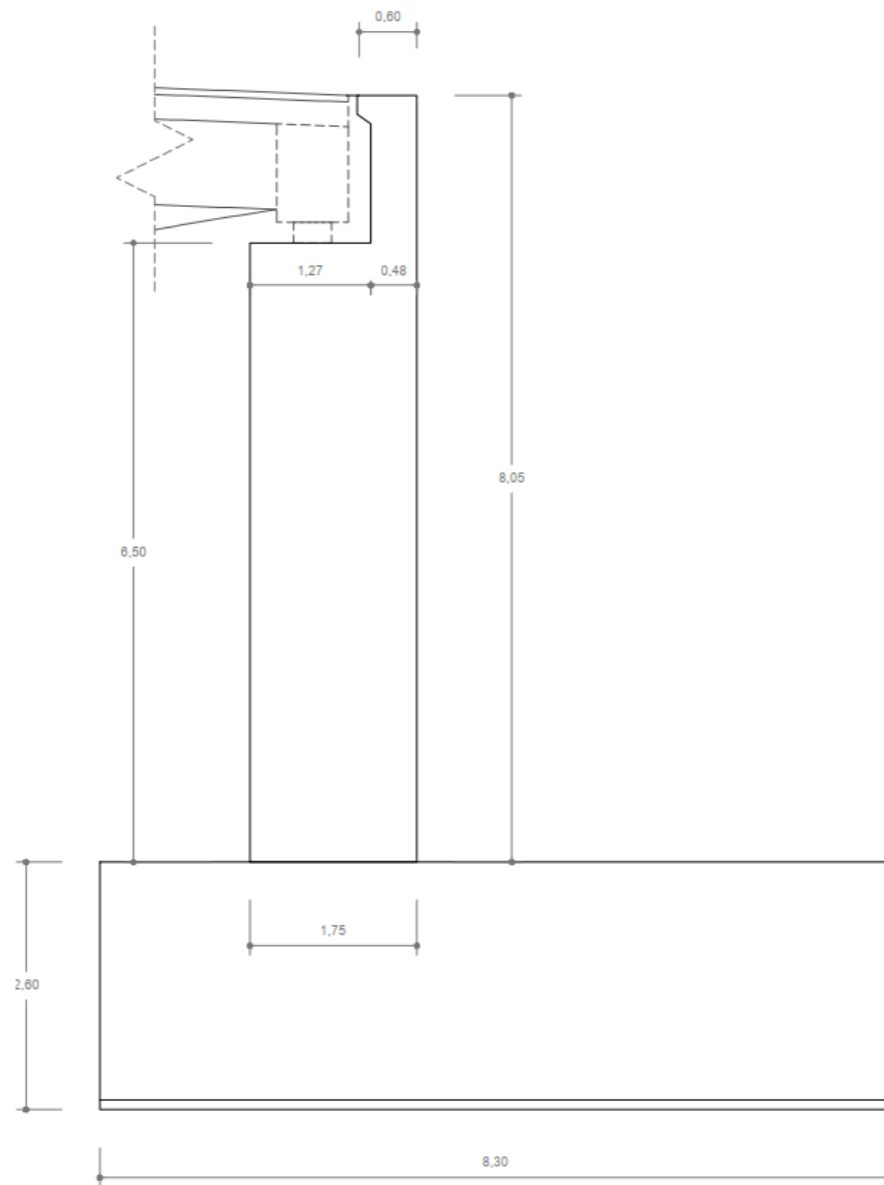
Vista en alzado de los estribos con las zapatas (fuente: elaboración propia)
